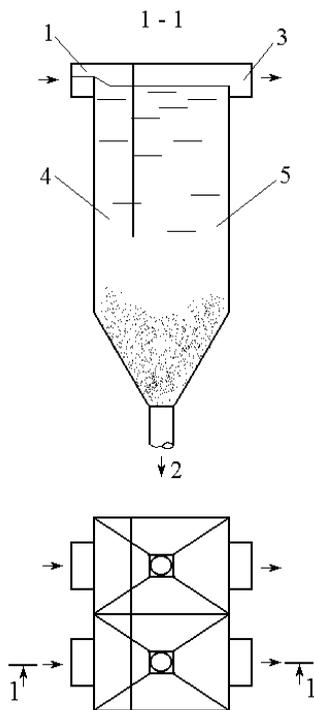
Песколовка с круговым движением рабочего потока
